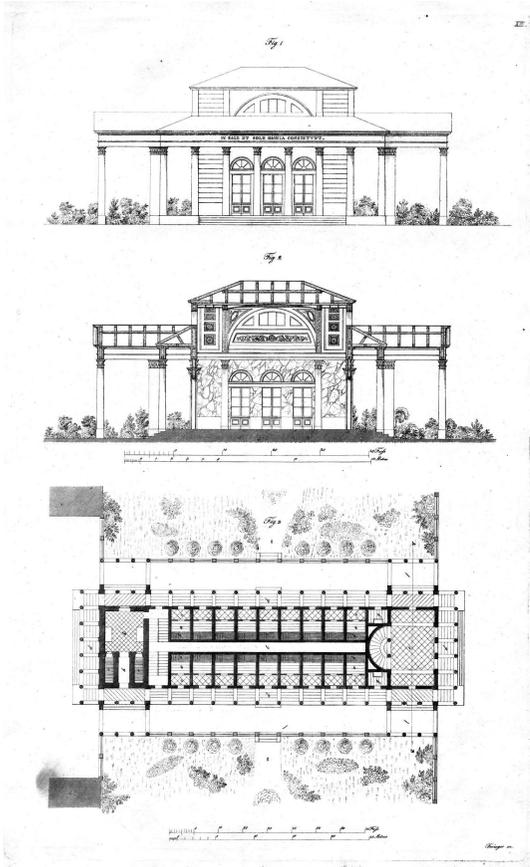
Ischl, Soolbad (1828), élévation latérale, coupe et plan (tiré de : AB, 1836).
